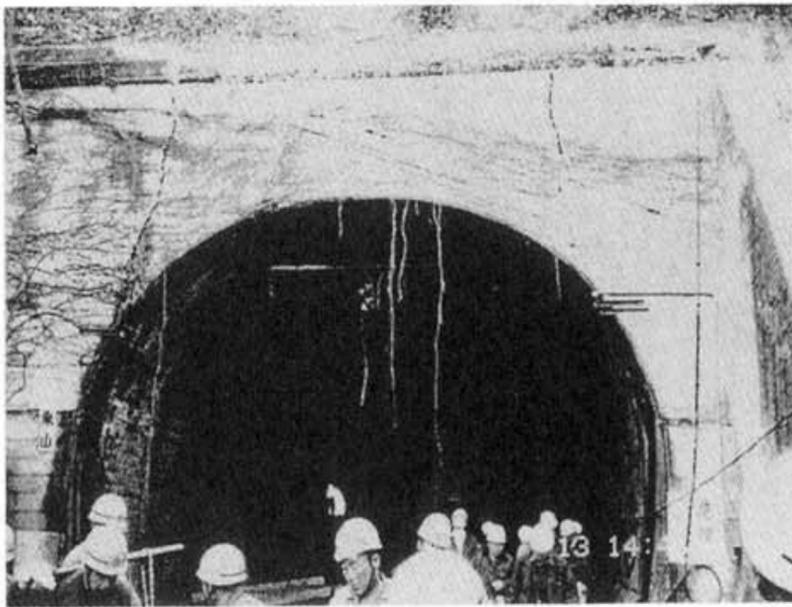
東山トンネルに生じた坑口部のひび割れ
